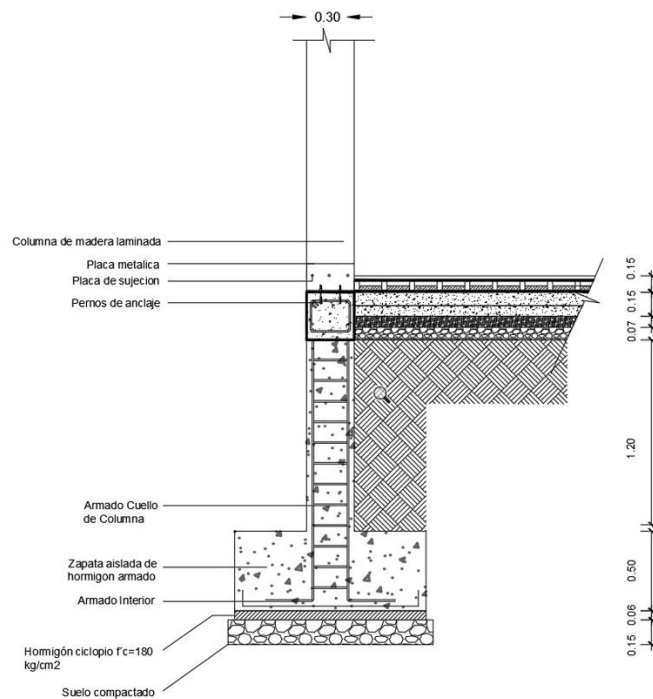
Detalle constructivo de cimentación de zapata aislada
